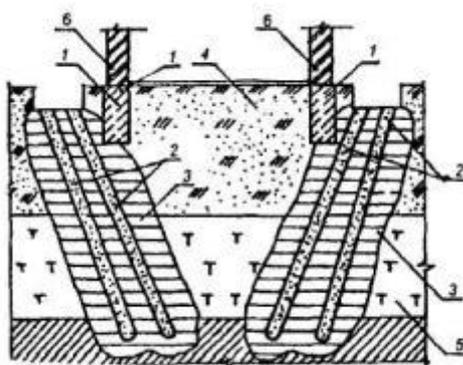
1- существующие фундаменты; 2- песчаные сваи; 3- зоны уплотнения; 4- насыпной грунт; 5- торф; 6- кирпичные стены.
